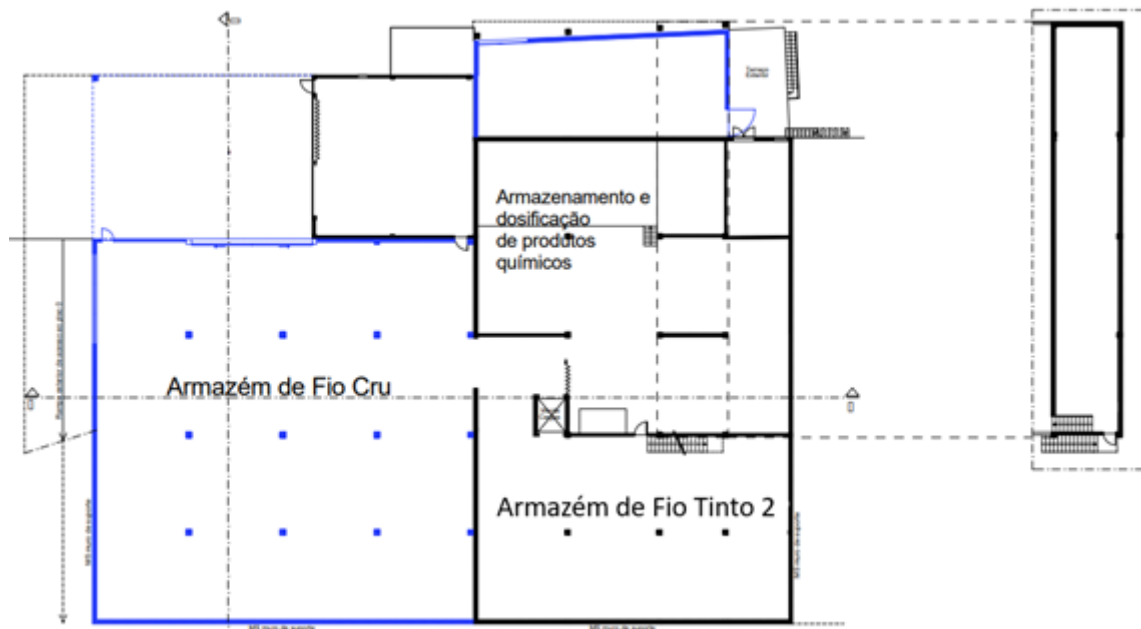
Layout do piso -1 do edifício da unidade fabril.
